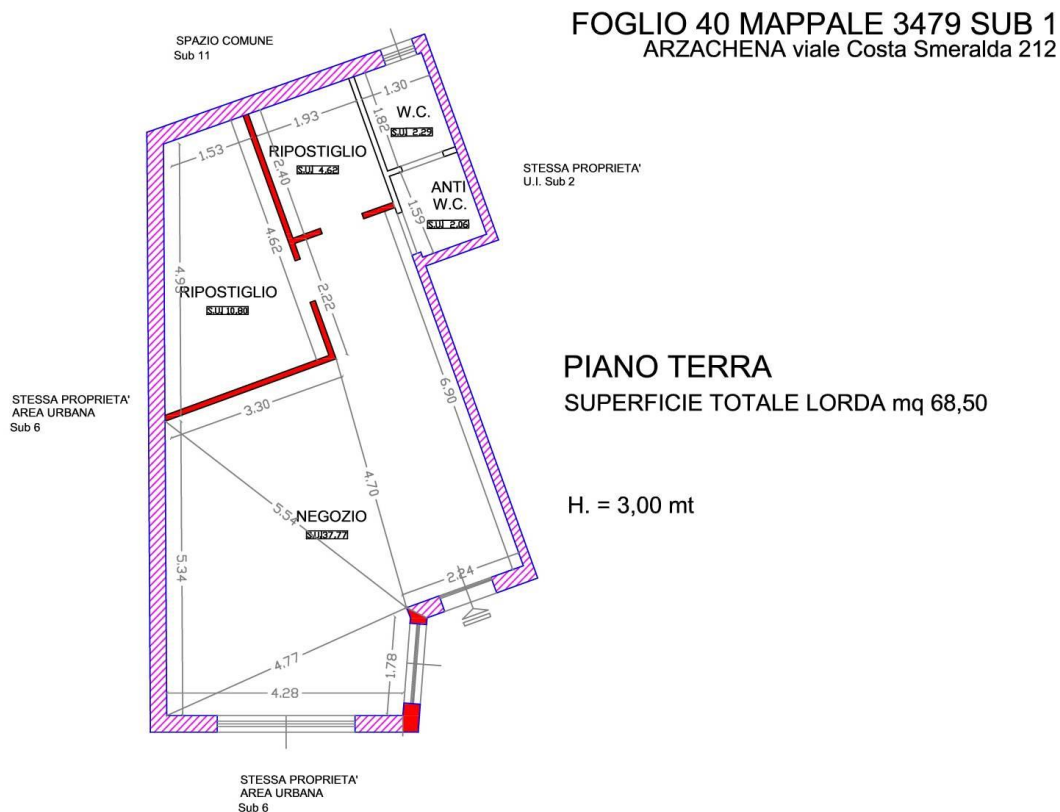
Pianta del locale commerciale dopo rilievo primo accesso
